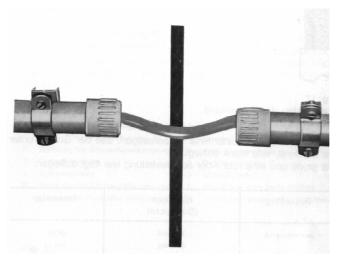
Interruzione del tubo di protezione su un giunto di dilatazione
